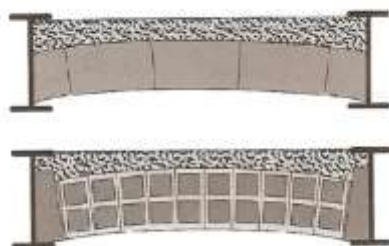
Pavimento em estrutura metálica (Pereira, 2013).
